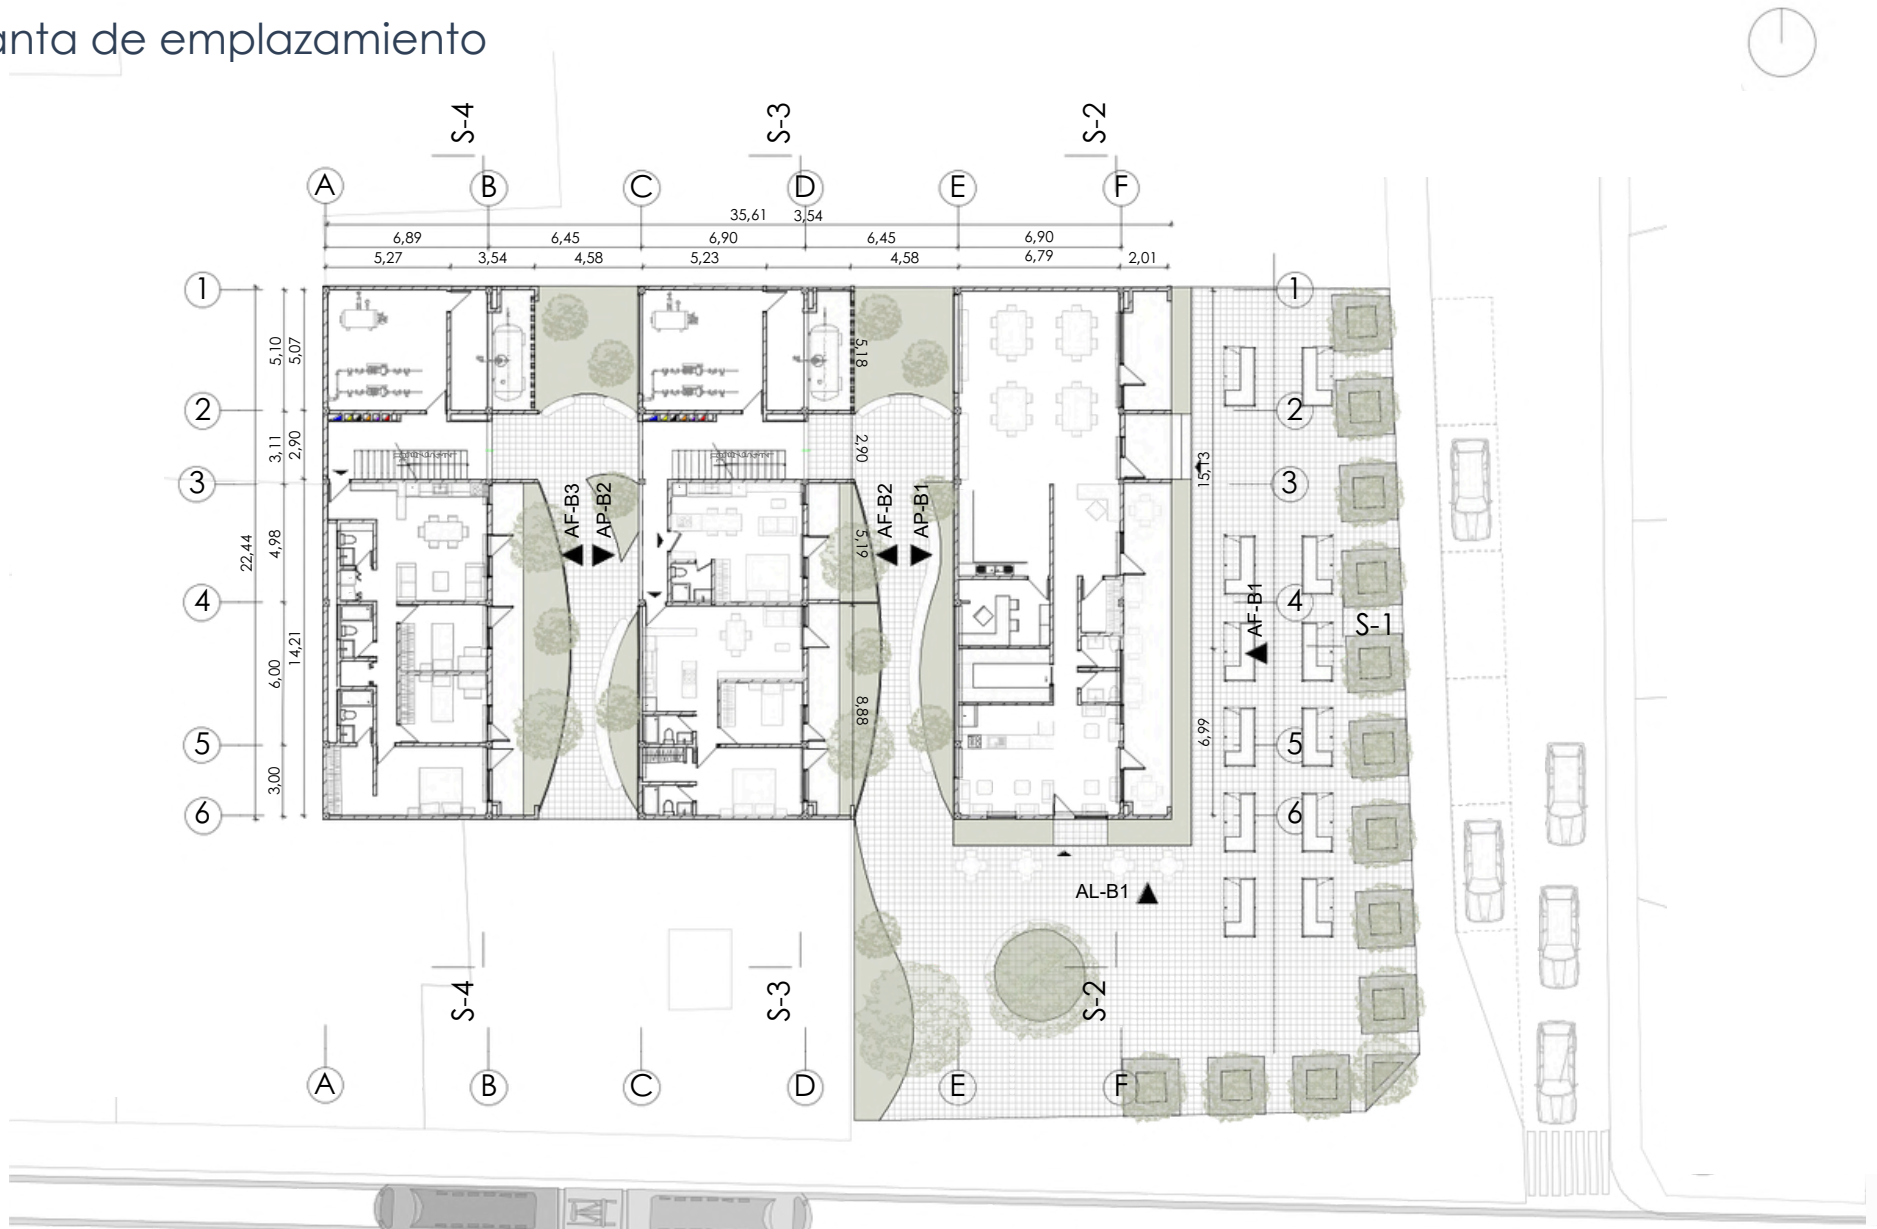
(planta de emplazamiento) 2026, Autoría propia.
